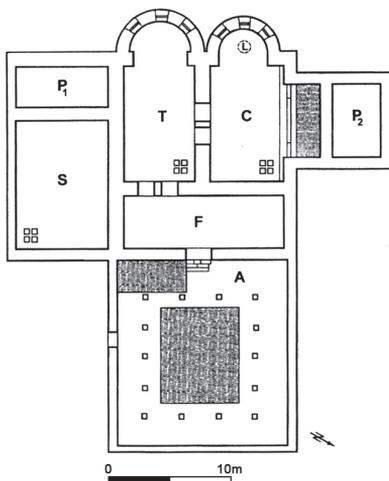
Grundrissplan Bauphase 1b. Das Apodyterium ist als basilikale Halle rekonstruiert. Für die Apsis des Caldariums ist ein Springbrunnen vorgeschlagen.
